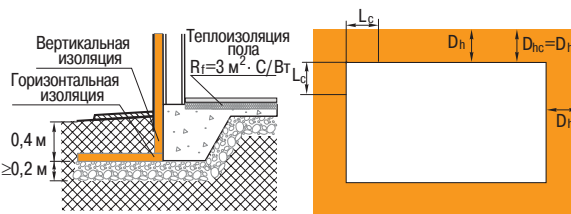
Схема поперечного разреза и план расположения изоляционных плит «Пеноплэкс®» для отапливаемых помещений при теплоизоляции пола $R_f=3$
